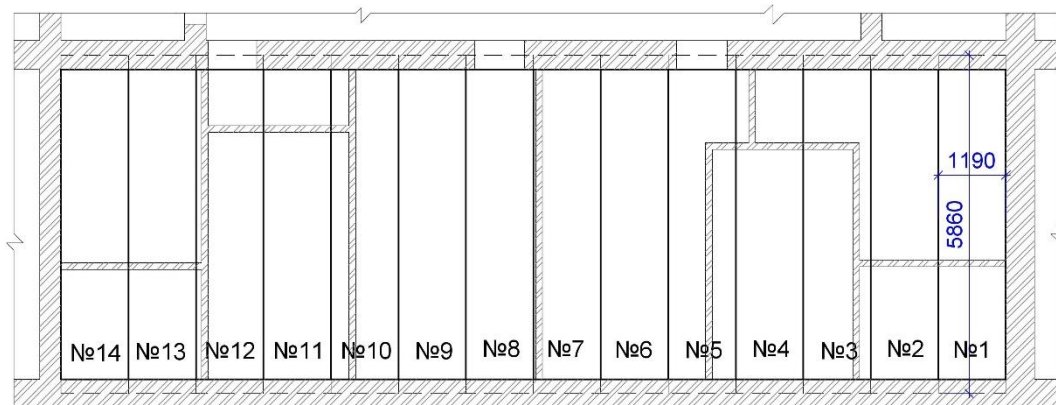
Фрагмент плану 1-го поверху з розкладкою кругло-порожнистих плит перекриття над підвалом (№1 - нумерація плит в зоні дослідження)
